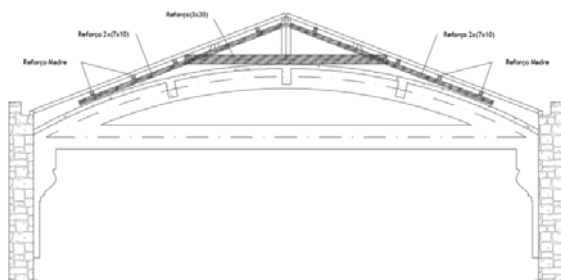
Exemplo de pormenor de reforço da cobertura (edifício B) fonte: Projeto de Execução
